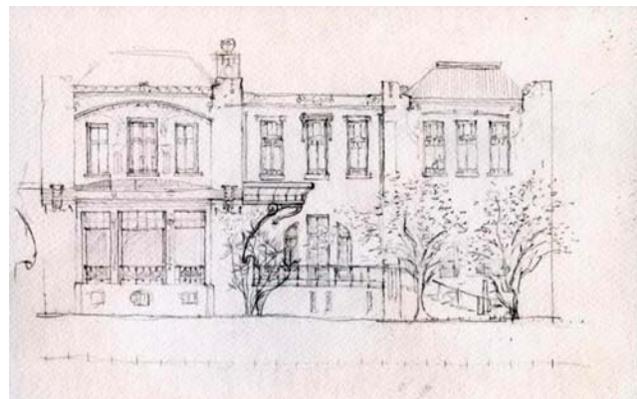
Eidotipo* da fachada norte da FAU-Maranhão e pormenor da mesma fachada.
